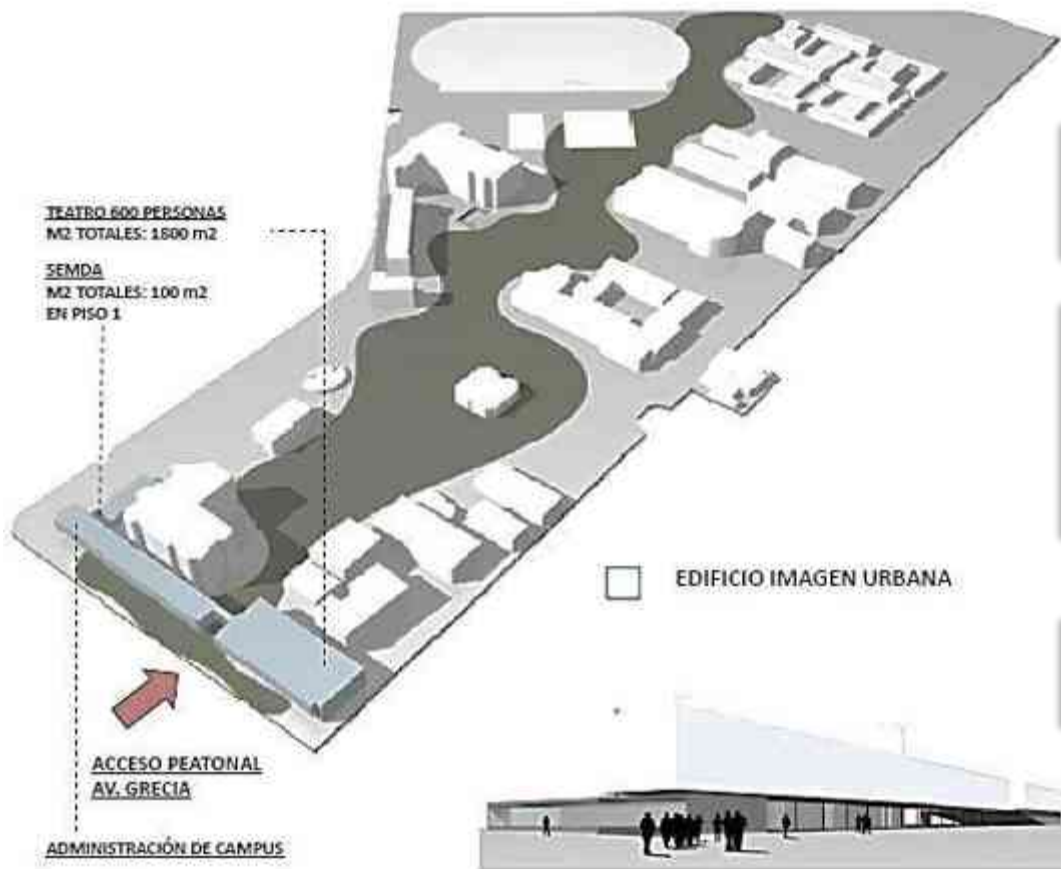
Plan maestro Juan Campos Millas. Edificio de identidad.
